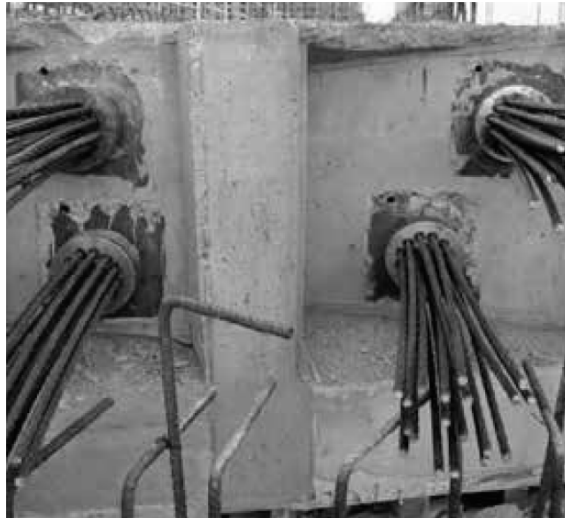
Hormigón postensado. Fuente: es.wikipedia.org/wiki/
